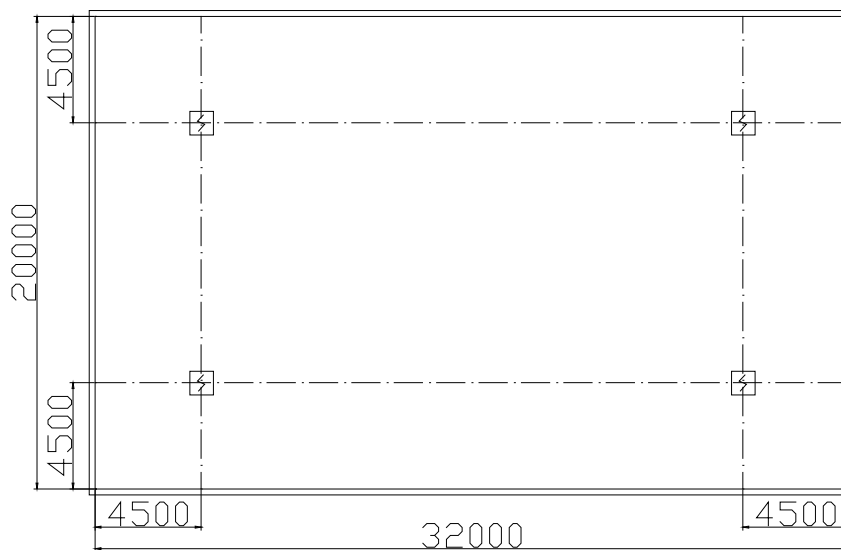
Схема размещения первых четырех пожарных извещателей
